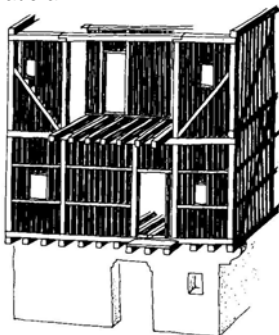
Casa de la Alberca, en la que su planta baja está construida con mampostería.¹¹⁷
